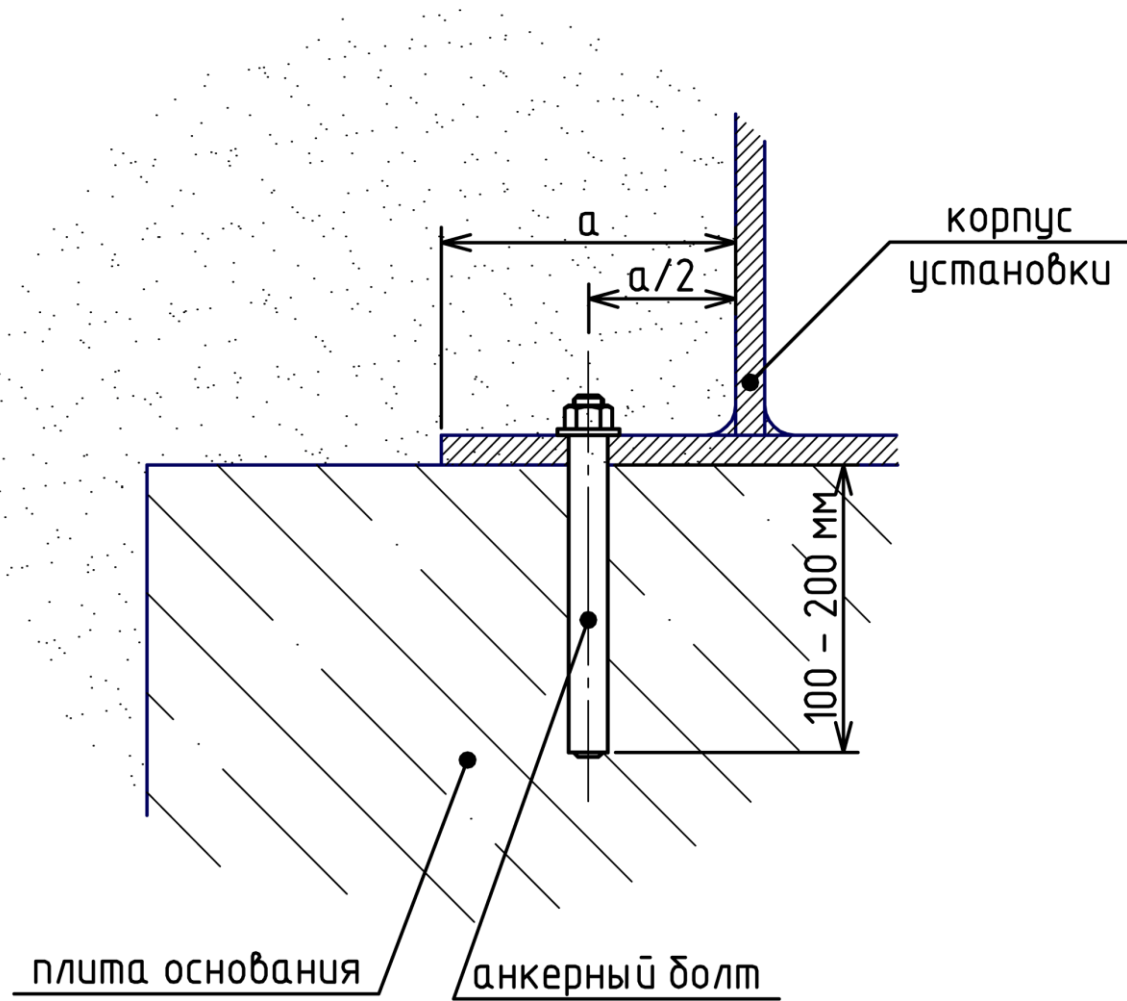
Узел крепления КНС к железобетонной плите
